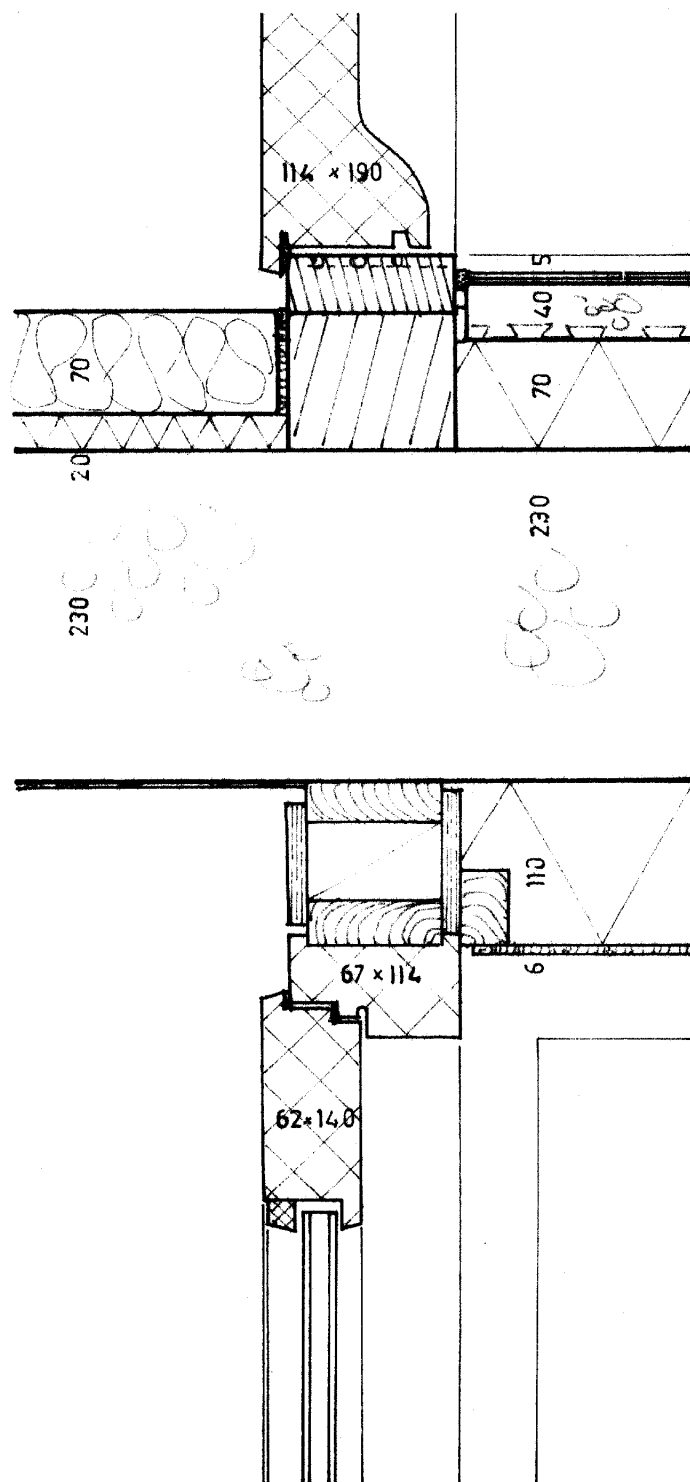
, 2, 3 en 4 RAAMKOZIJN
